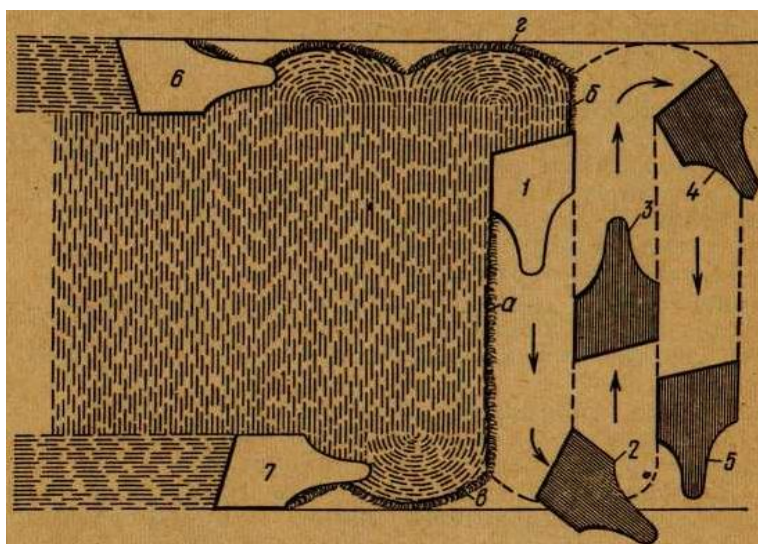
Схема шпатлювання великих поверхонь: 1-7 – шпателі в різних положеннях; а, б, в і з – напливи шпатлівки
